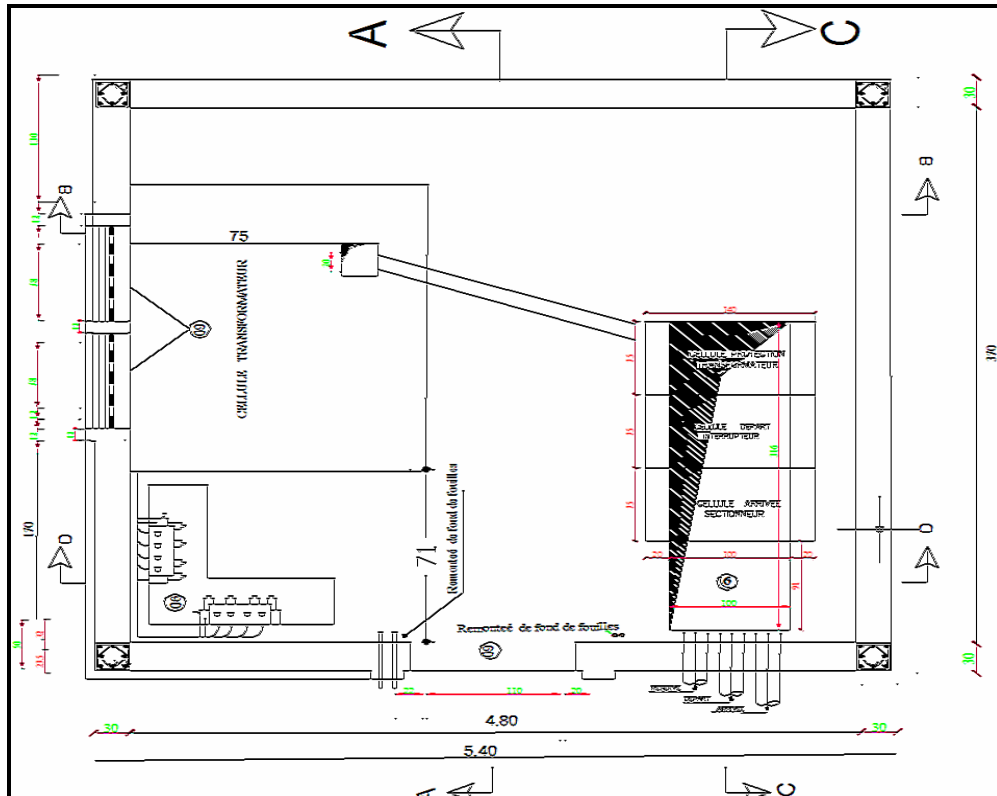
Plan d'équipement et de réservation d'un poste DP
